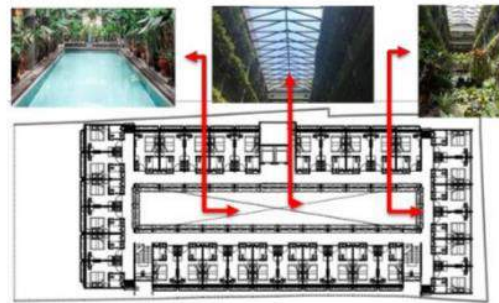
Denah Tipikal Lantai 1-4 Greenhost Boutique Hotel
